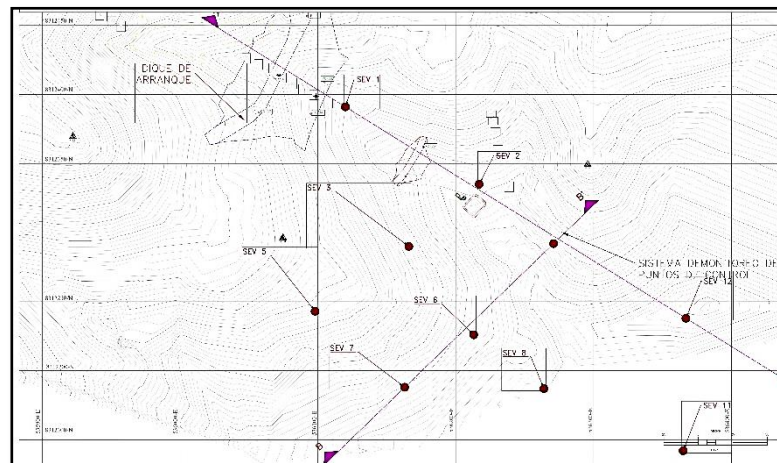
Vista en planta de plano de ubicación de los puntos de sondajes eléctricos verticales (SEV), con los ejes de sección geofísica A-A' y B-B'.
